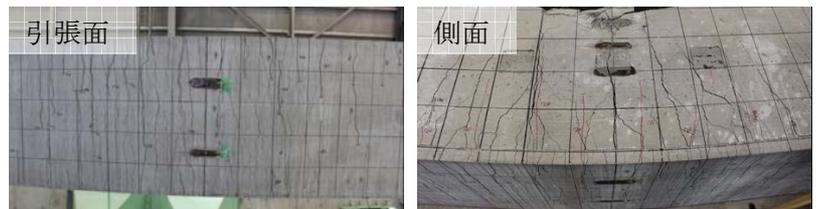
試験後のひび割れ発生状況 (No. 3)
